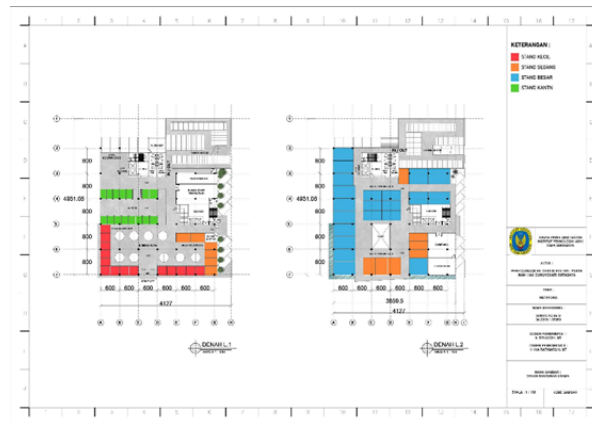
Ruang sebelum re-desain hanyan 2 lantai
